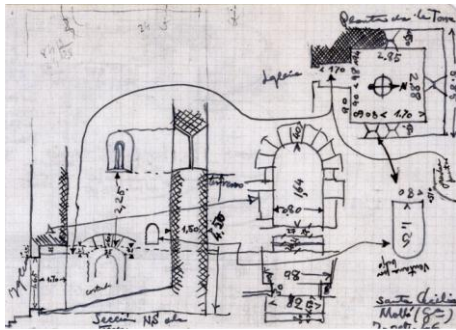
Molló. Iglesia de Santa Cecilia AAFV. Croquis detalles muros y ventanas y croquis de la planta
